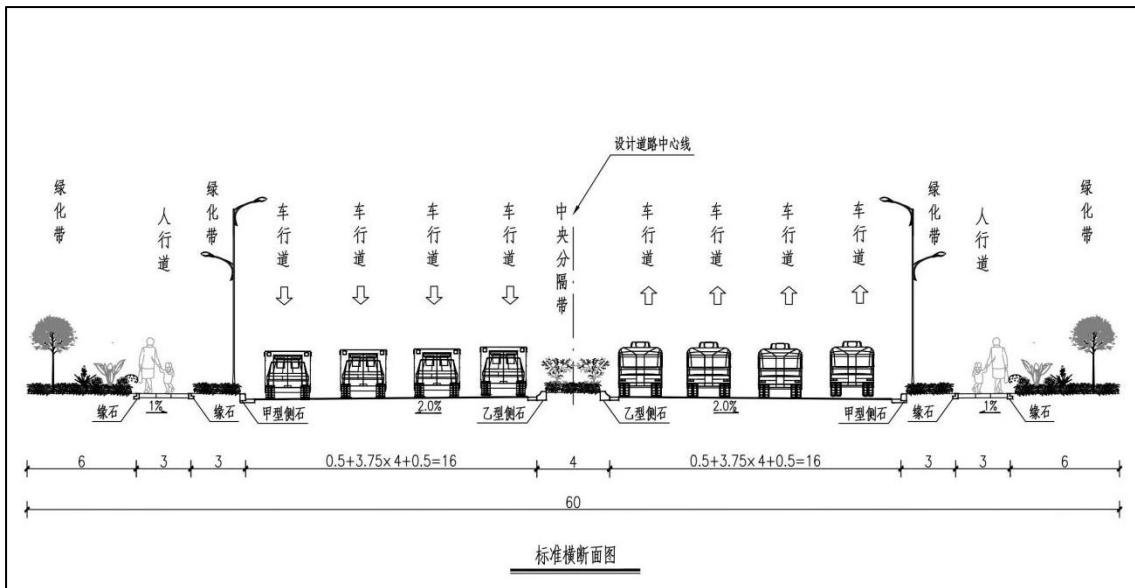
新石化大道（创业路-南堤路）段横断面布置图
